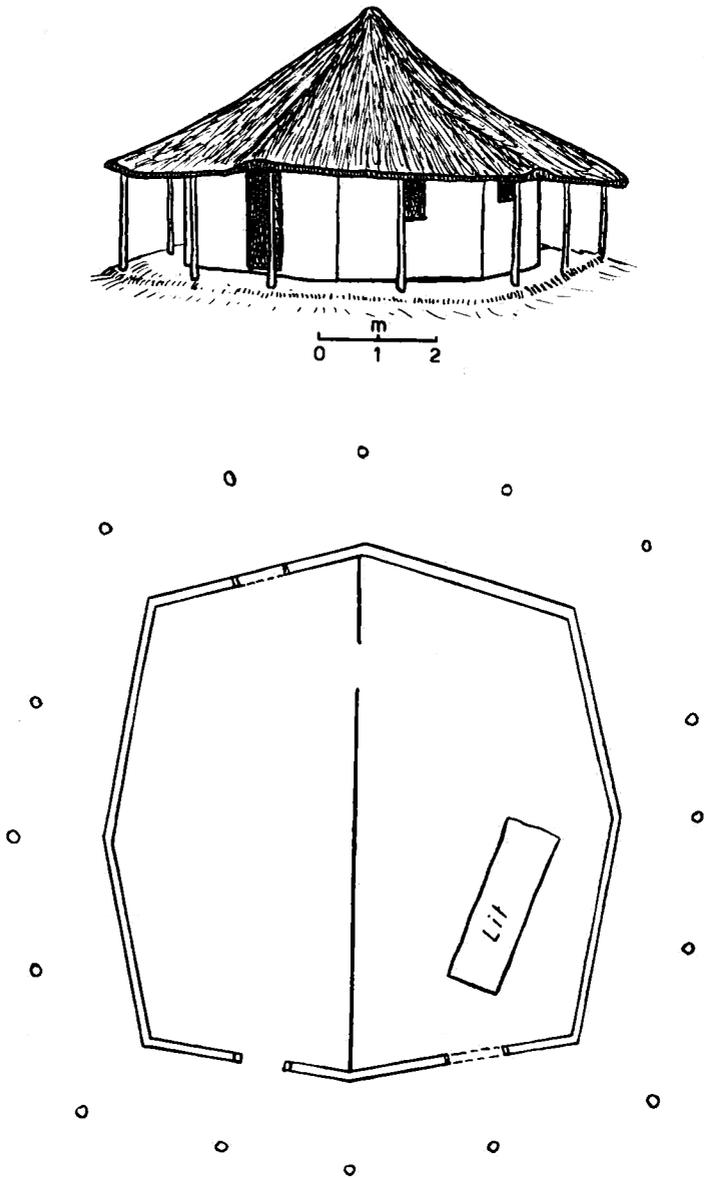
Vue générale et plan d'une grande case baluba (même village que la case de la fig. 9).
